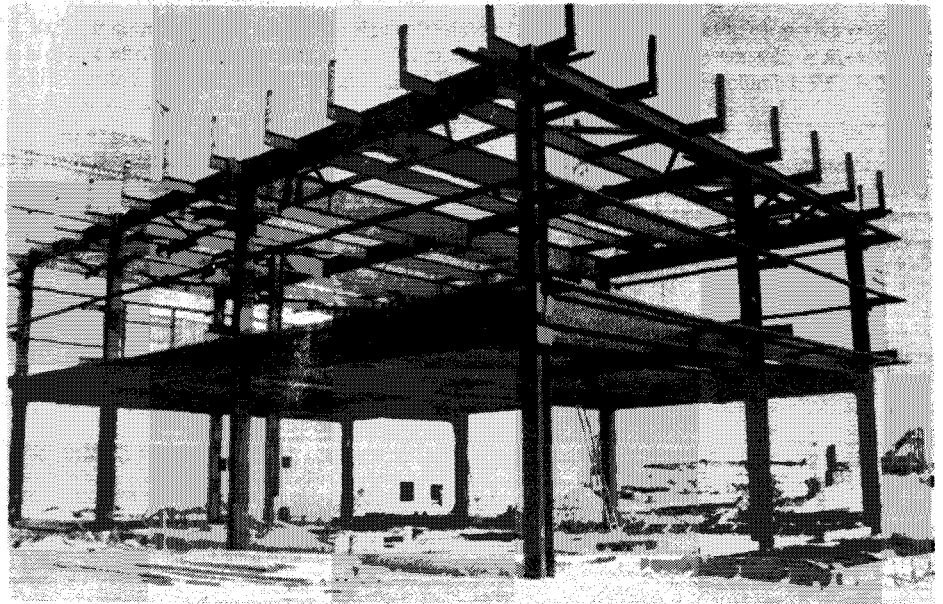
Figura VII-I Vigas-columna y vigas formando una estructura industrial. Obsérvese la orientación alternada de fuertes ejes de vigas-columna a los lados de la estructura, Un acercamiento de las juntas seleccionadas se muestra en la figura 9-15.
